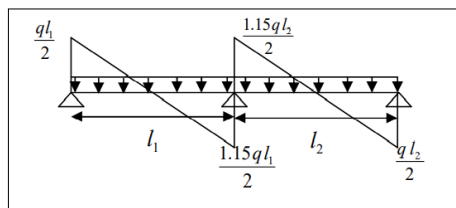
Effort tranchant d'une poutre à 2 travées.
